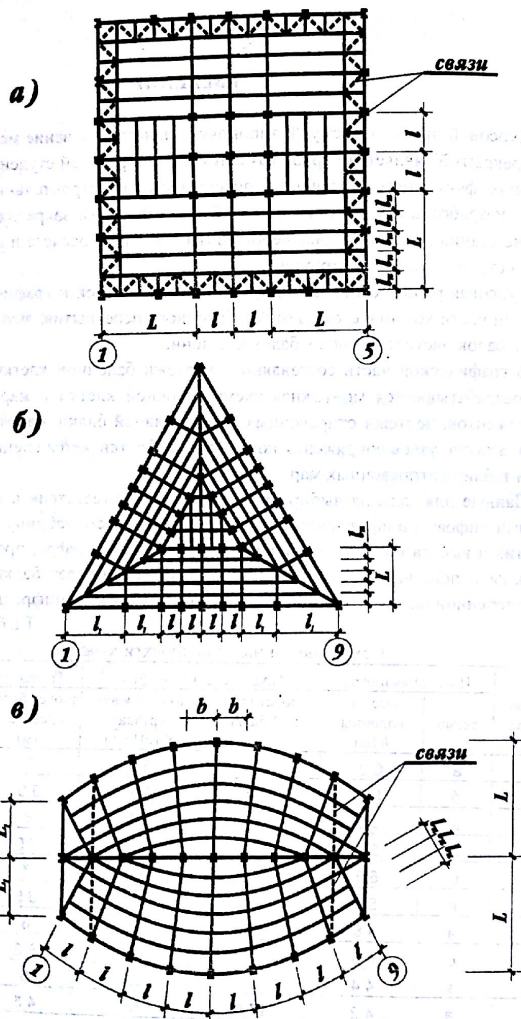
Компоночные схемы междуэтажных перекрытий
